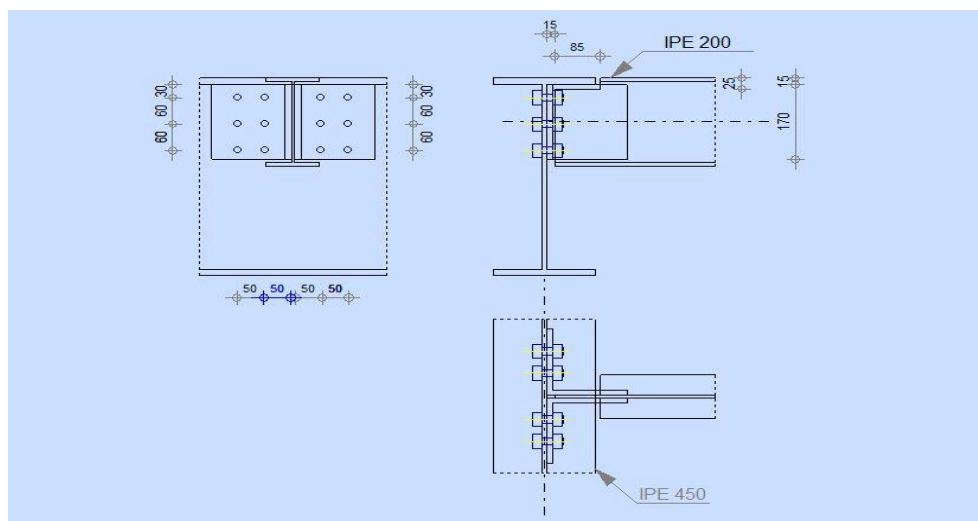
Détail sur l'assemblage poutre maitresse poutre secondaire.
